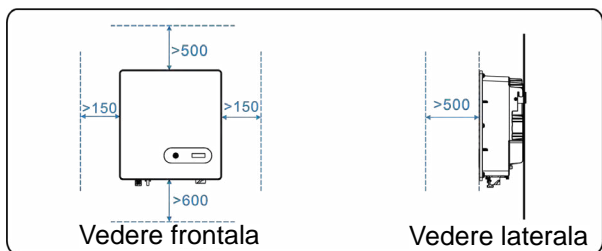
Cerințe privind spațiul de instalare(mm)
